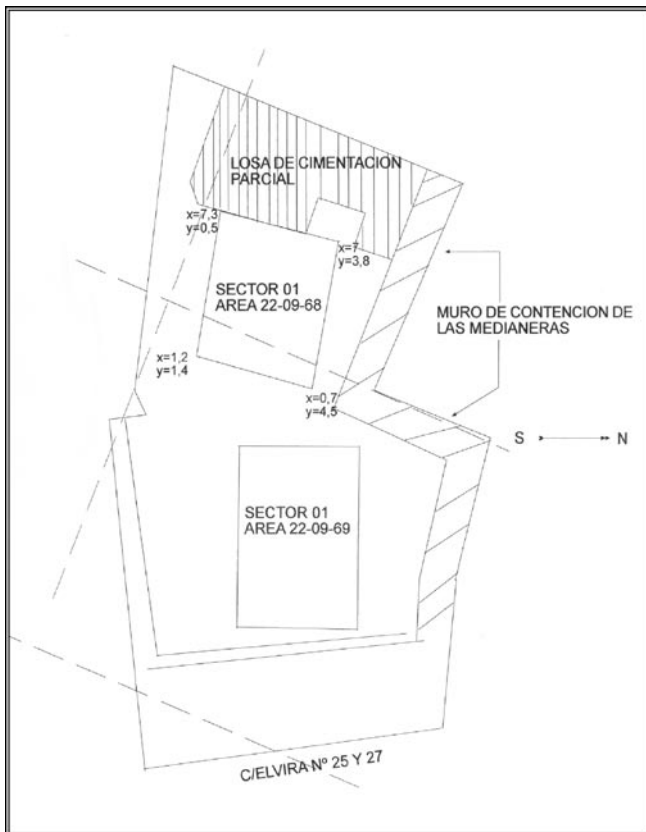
Planimetría general. Ubicación de sondeos. E. 1:100.
